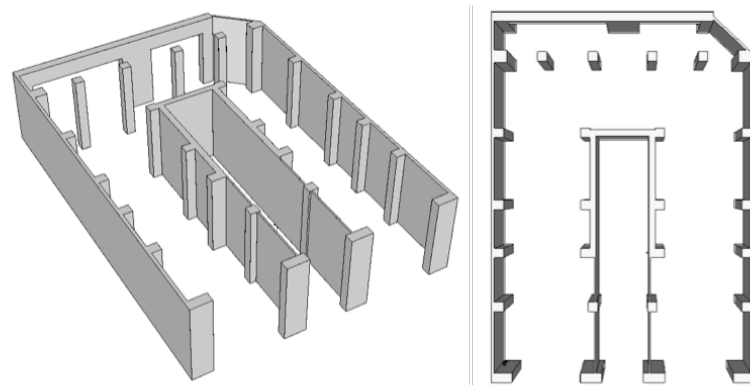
Planta baja del edificio ED-03. Izquierda: vista isométrica. Derecha: vista en altura (fuente: elaborado por el autor)
